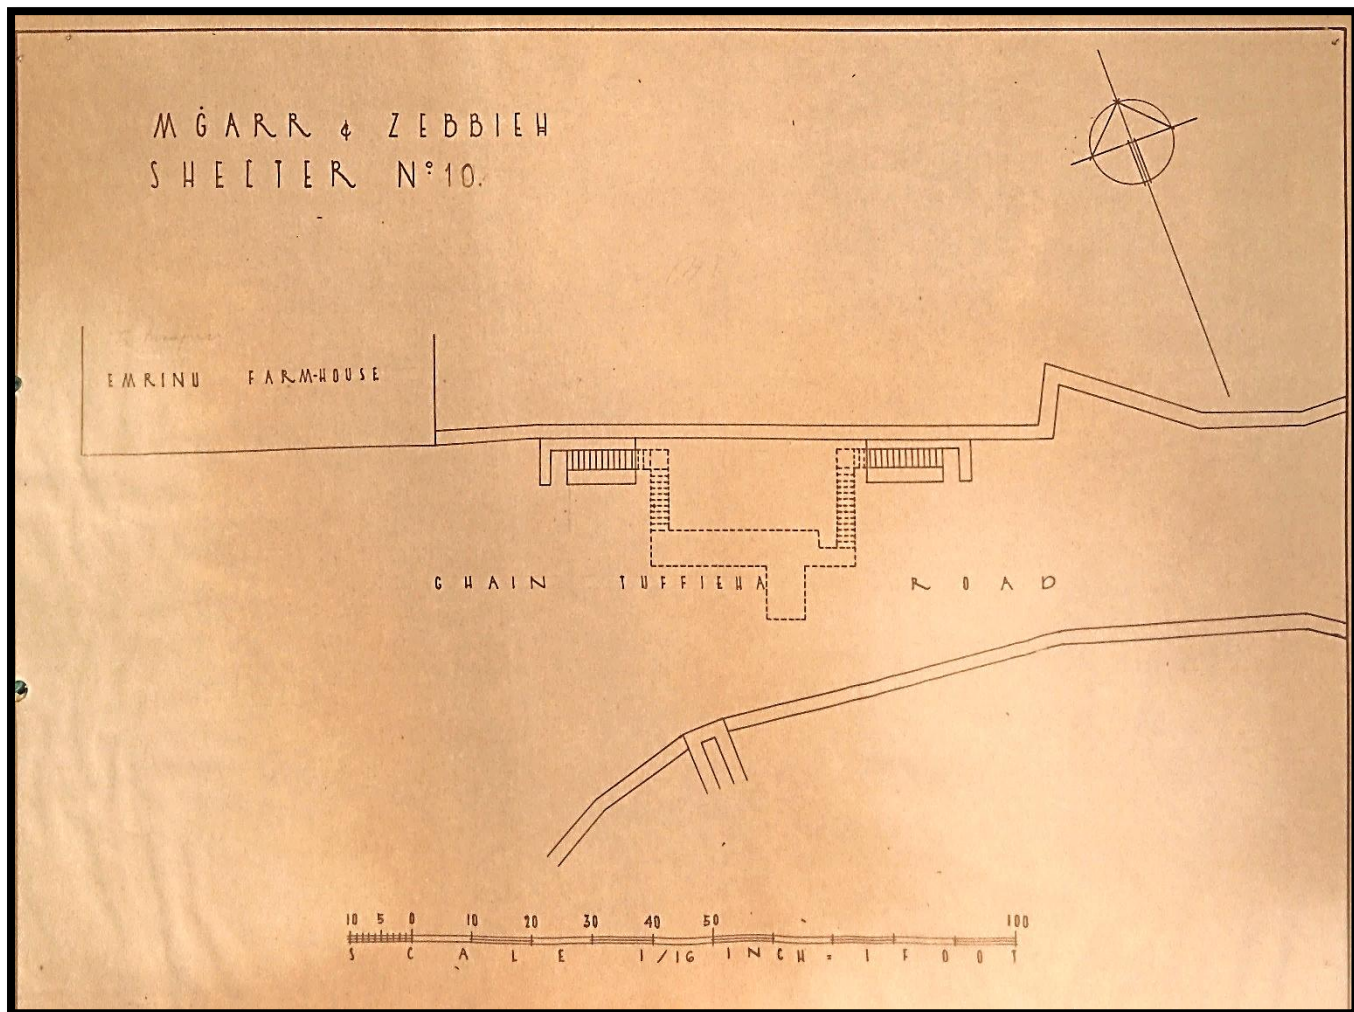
Planta do Abrigo nº10 "Ghain Tuffieha Road."
